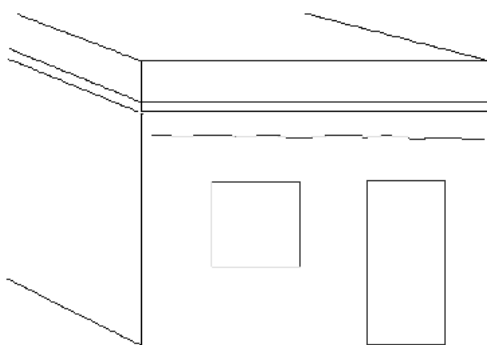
Fisura provocada por dilatación de losa de techo
